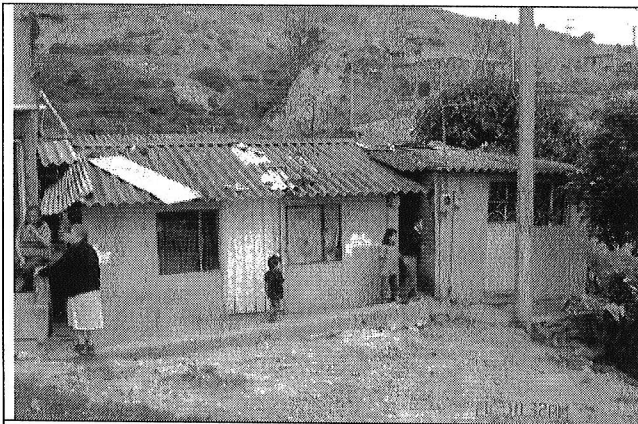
Vivienda de la Transversal 73H No. 67B-61 Sur – Mz 1 Lote 2 (imagen tomada de las fichas oficina de Gestión Territorial - DP AE).
